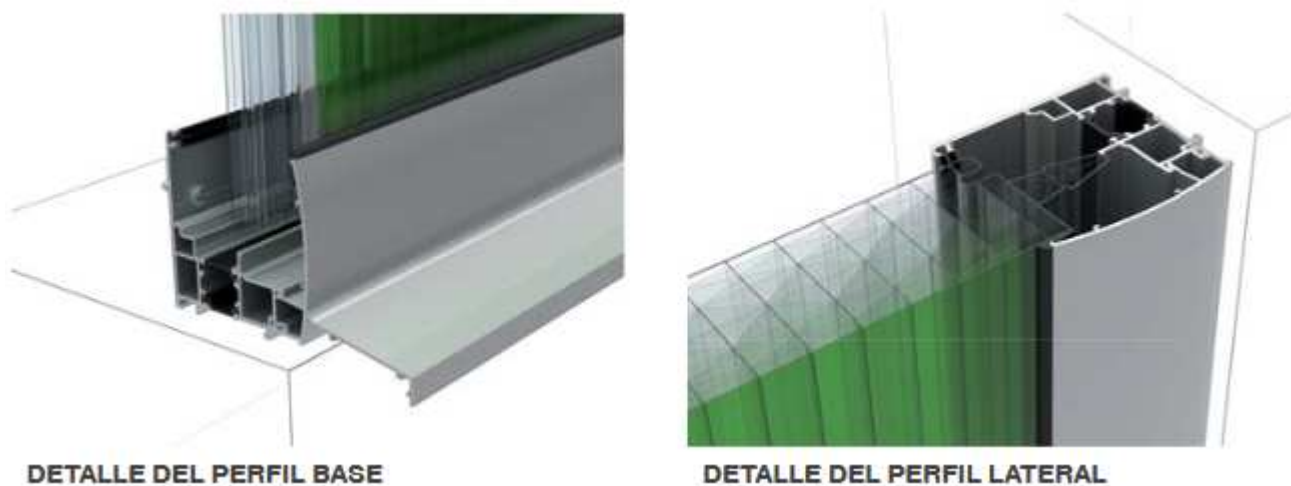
Detalles de perfilera ArcoWall 5613 Fuente: Aislux 2016
